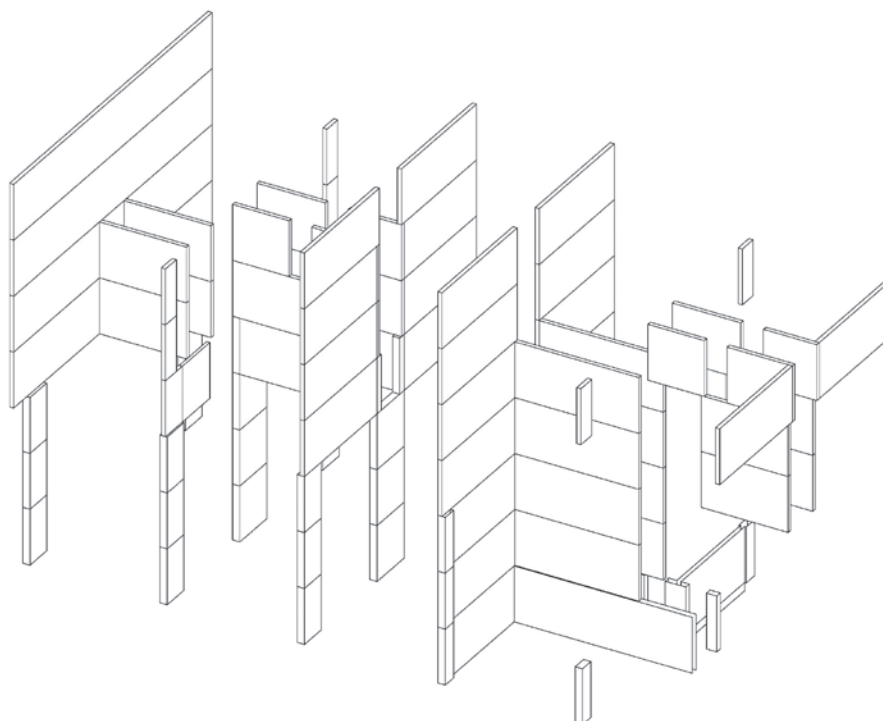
Estructura del tramo A del bloque 2. Fuente: Elaboración propia.
